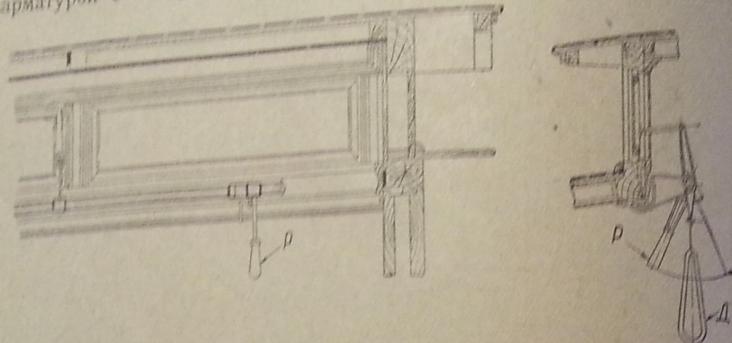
Световой фонарь: *P* — ручка механизма для открытия форточек, *D* — держатель ременный.
